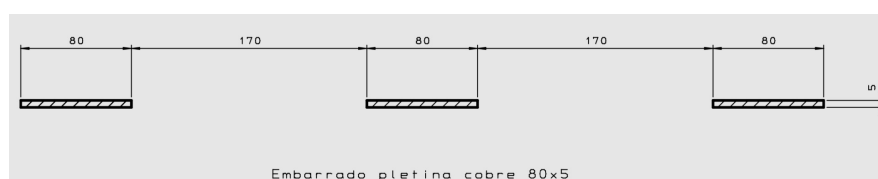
Detalle de pletinas: espesor, anchura, separación entre barras y disposición
